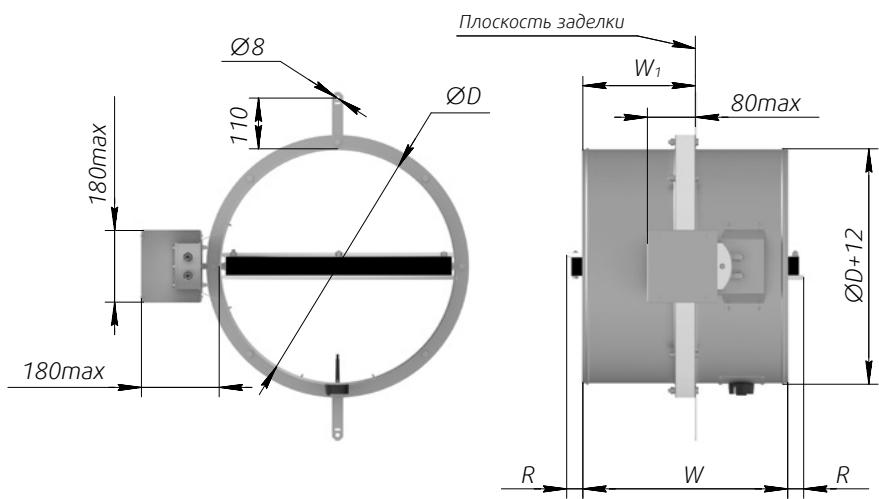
в. Размеры ниппельного клапана HELMER, EI90 (с возможностью стеновой заделки)
